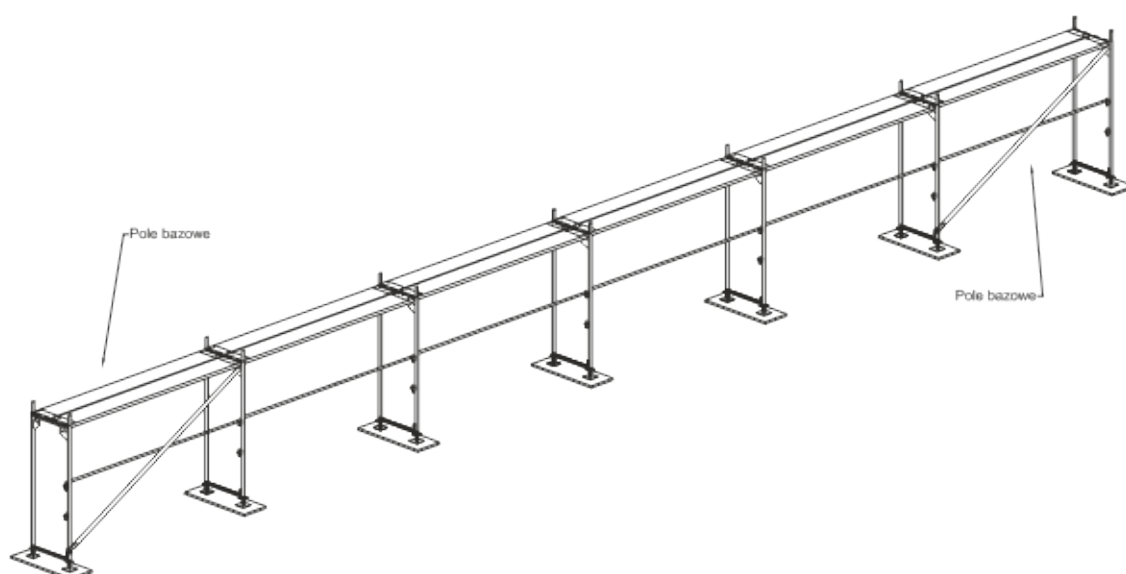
Zmontowane pole bazowe pierwszej kondygnacji
